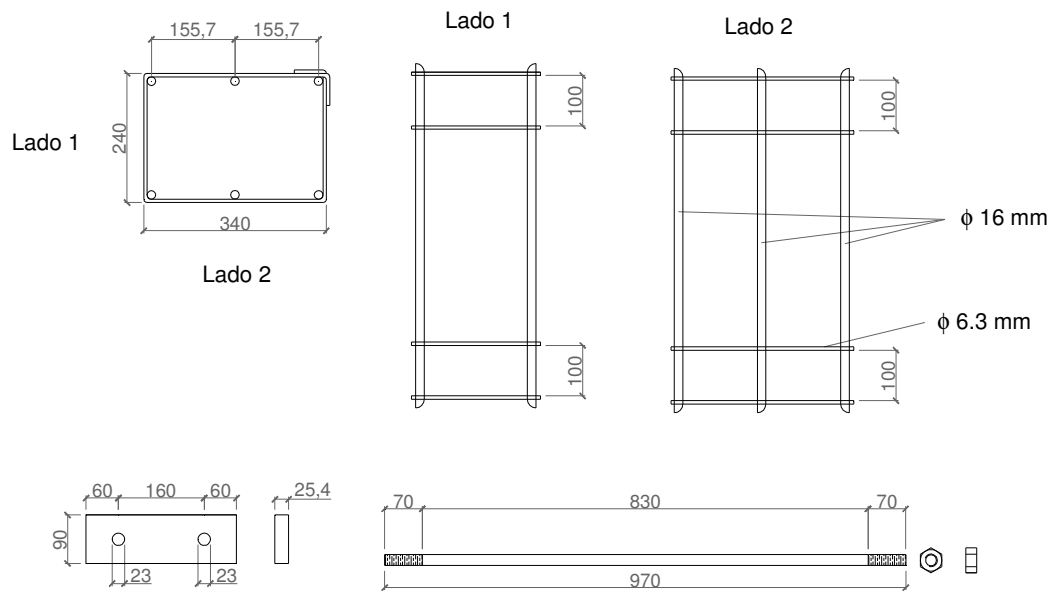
Detalhamento das armaduras para os modelos de chumbador com fibras de aço
